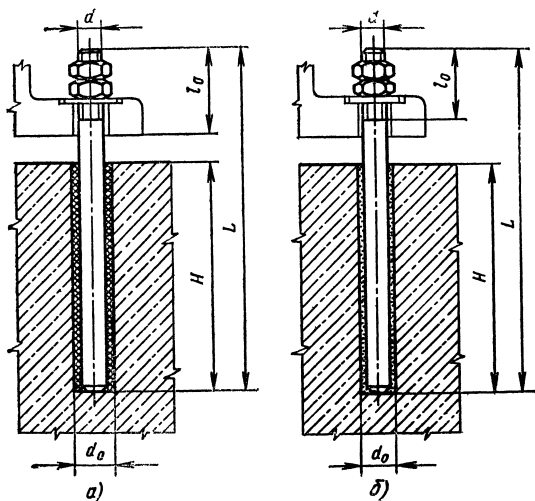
Фундаментные прямые болты, устанавливаемые:
